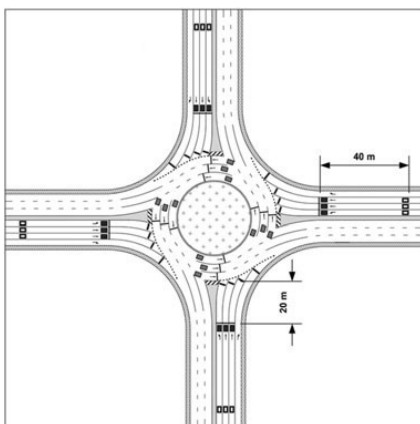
Plan faza u slučaju favorizovanja levih skretanja
